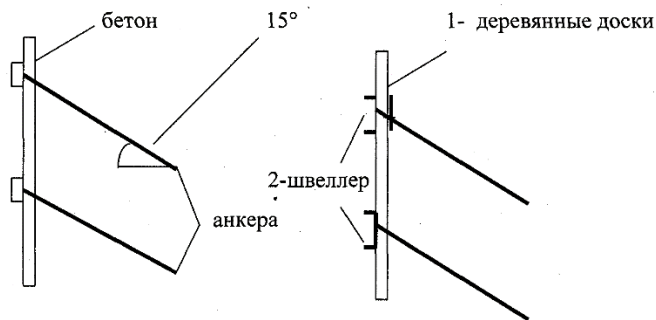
Рекомендуемые типы крепления стен выработок тоннелей для скального грунта
